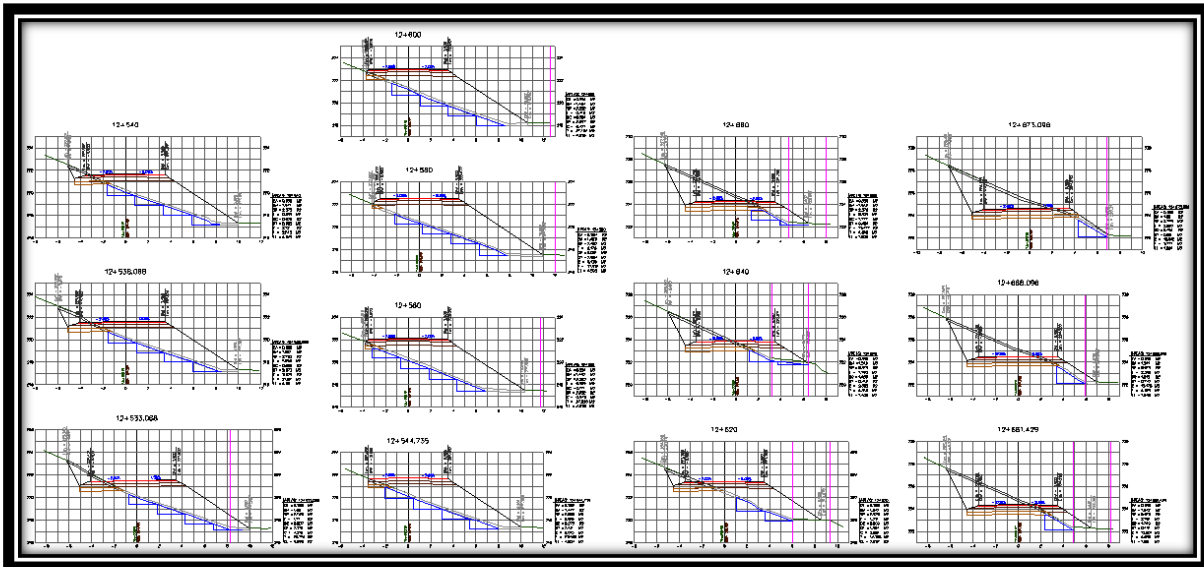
Secciones de construcción del km 12+533.068 al km 12+673.096.
